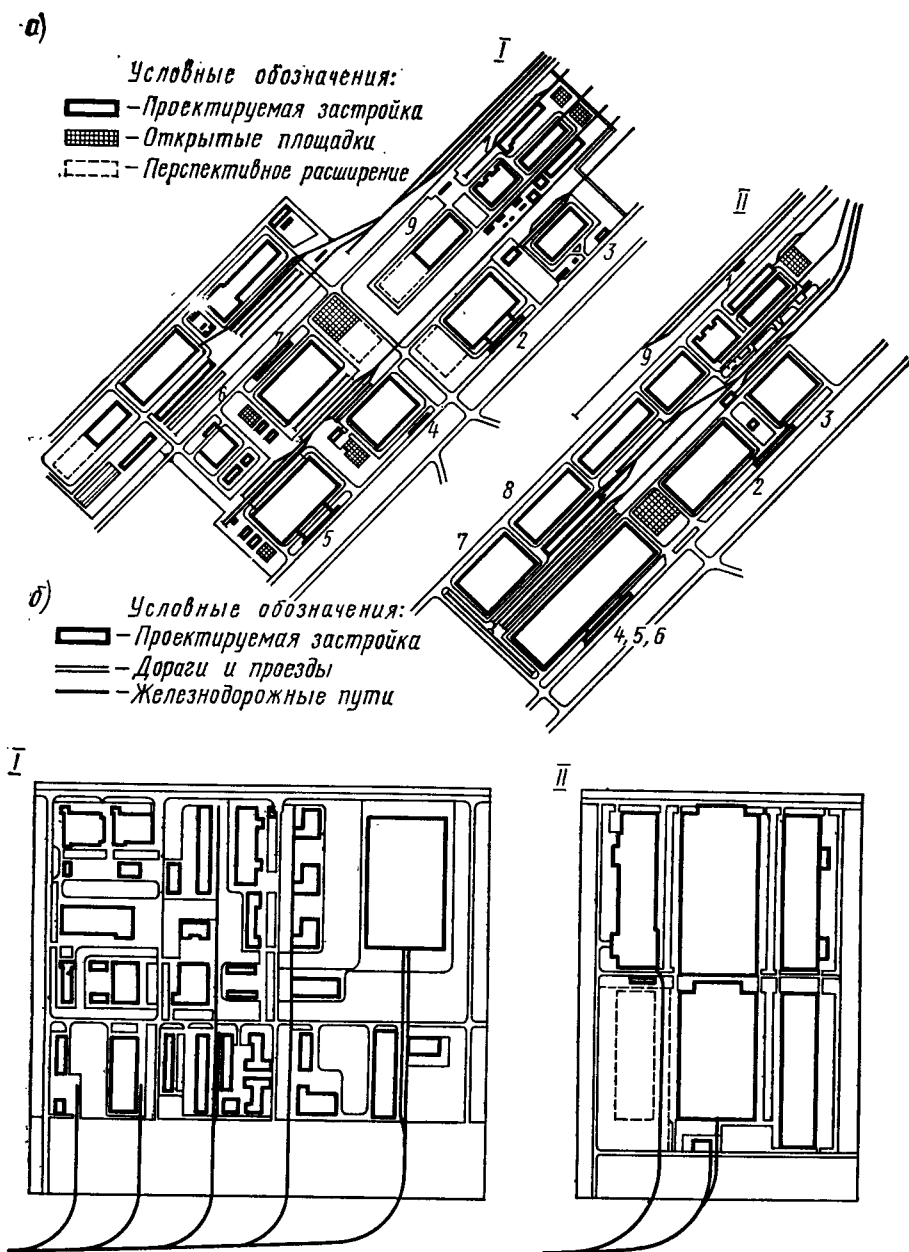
Схема генерального плана промышленного узла из предприятий:
